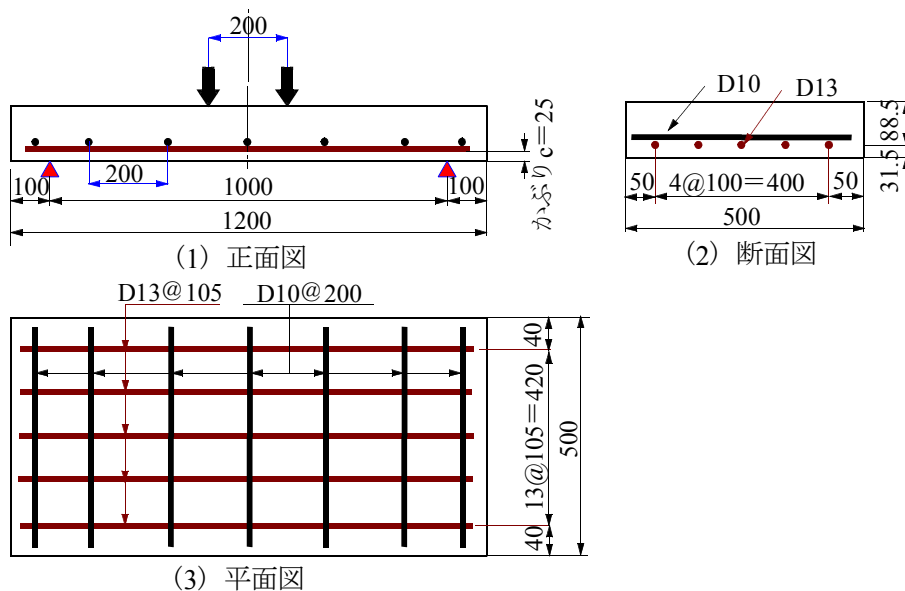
供試体寸法および鉄筋配置 (RC-A)
